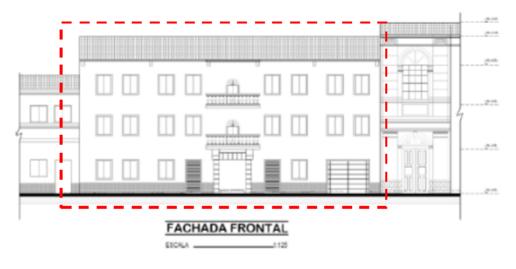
Fachada Propuesta. Fuente: Planos Arquitectónicos, 2021.
